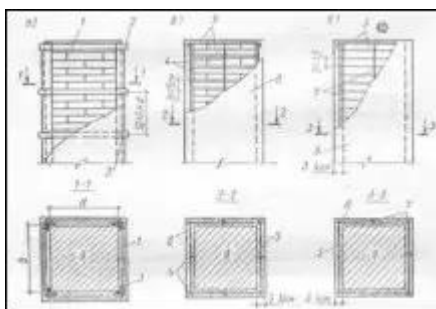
Усиление каменных столбов стальной (а), железобетонной (б) и армированной растворной (в) обоймами:
